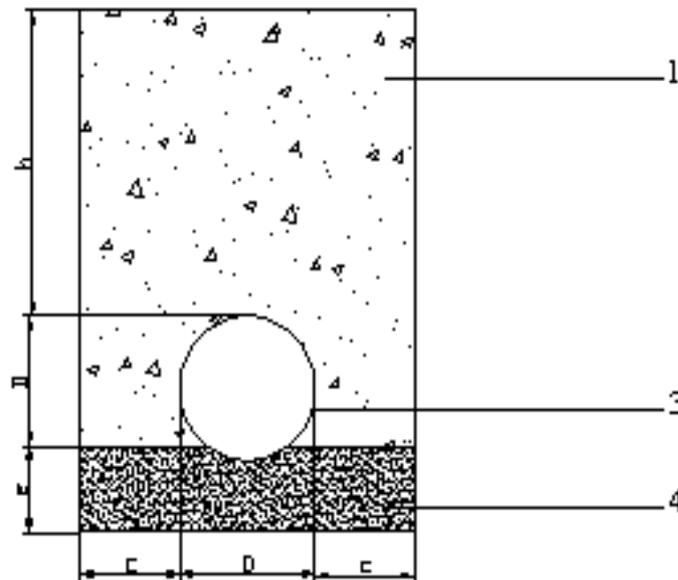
Coupe transversale d'une tranchée avec la mise en place de la conduite
